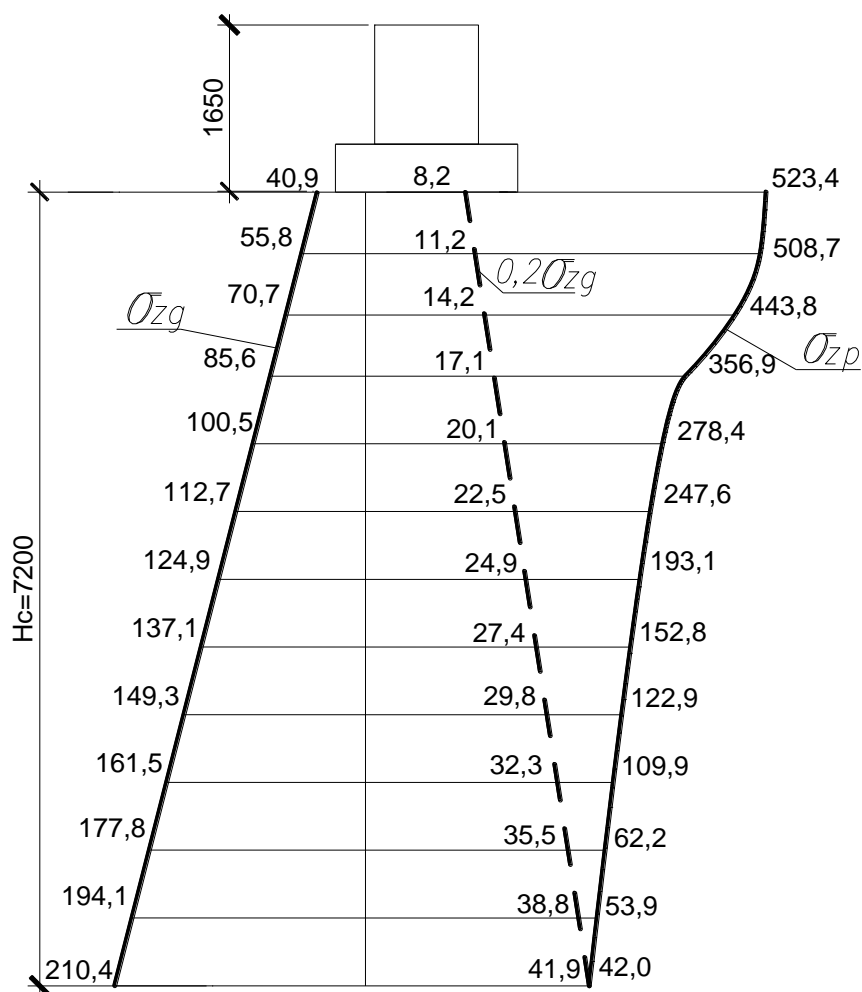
Епюри вертикального і горизонтального тиску для фундаменту
